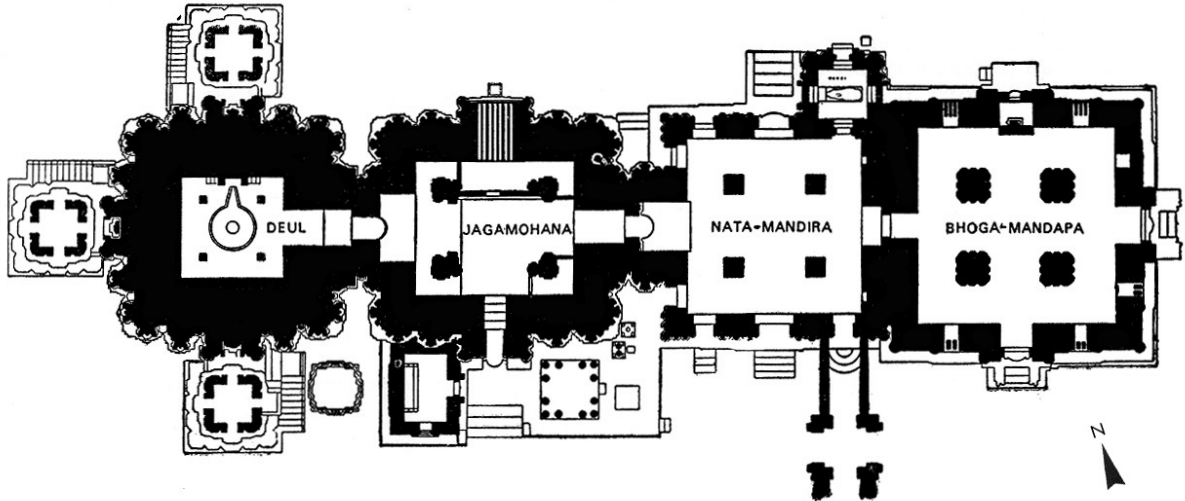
Grundriss Lingarāja-Tempel/Bhubanesvara
